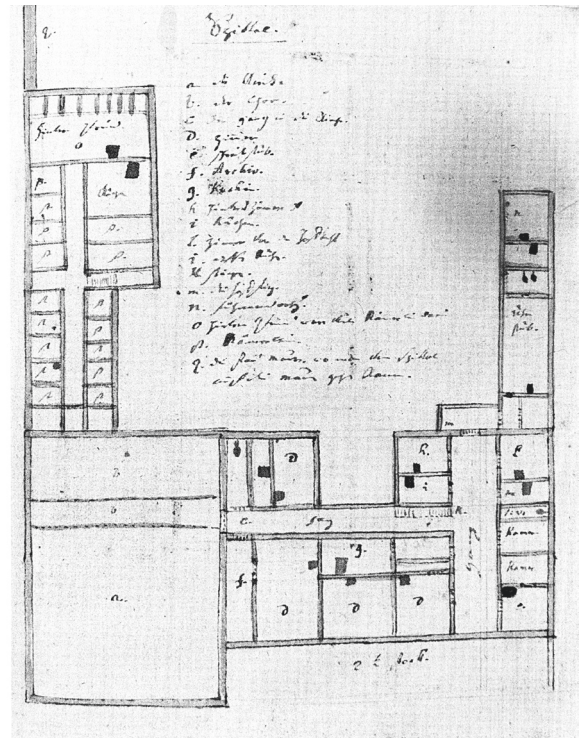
Schwäbisch Gmünd. Spital, Grundrisse Erdgeschoss und Obergeschoss um 1800 nach Debler.
